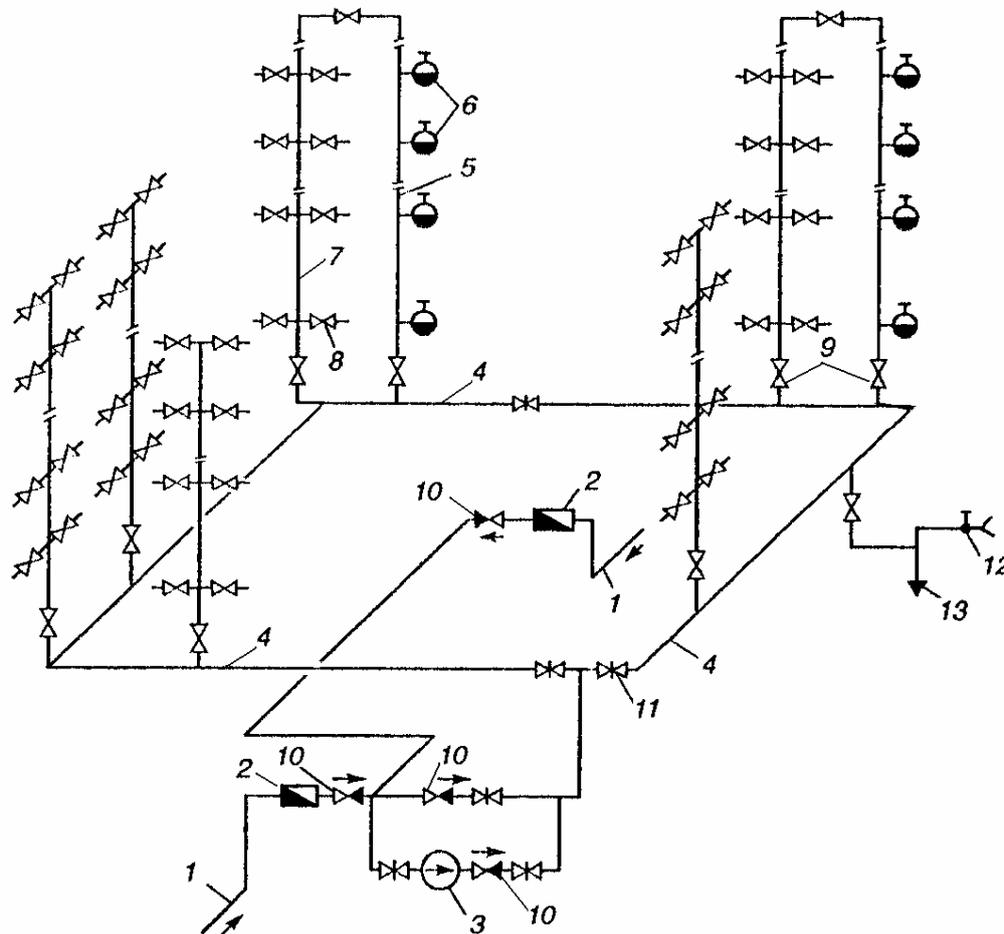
Схема внутреннего водопровода жилого дома с повысительной установкой.
